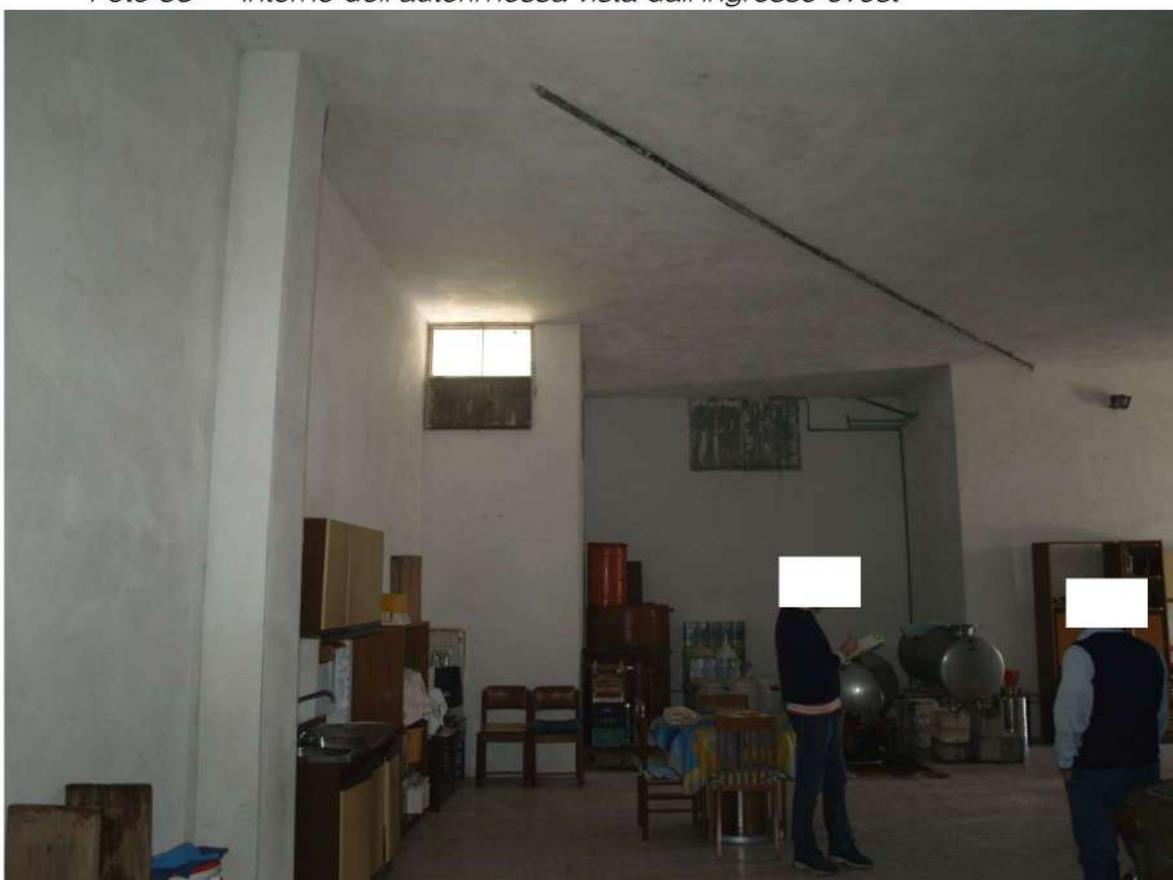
interno dell'autorimessa vista dall'ingresso nord
